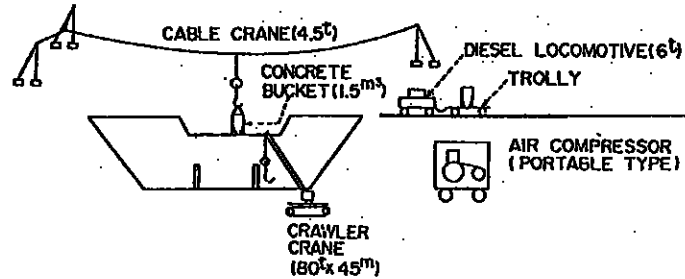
第1順位土砂制御施設事業のコンクリート工事方法
